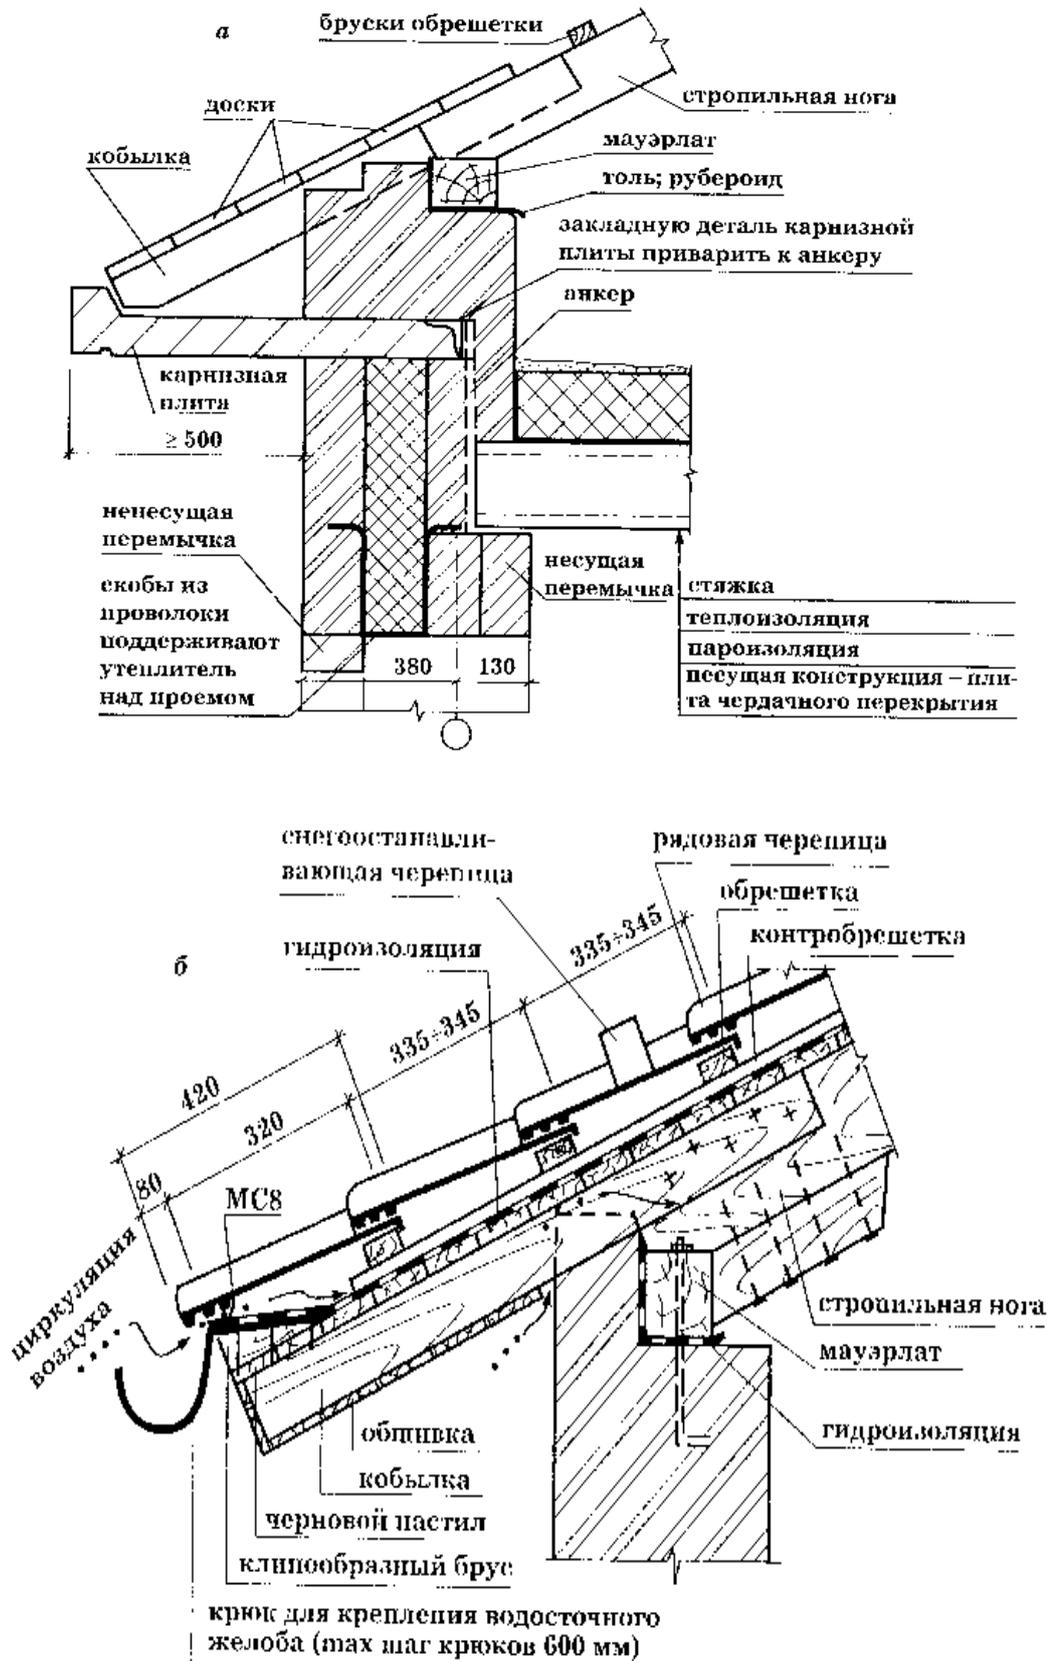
Карнизные узлы для чердачных стропильных крыш: а – карниз, из сборных железобетонных плит; б – карниз кирпичный.
